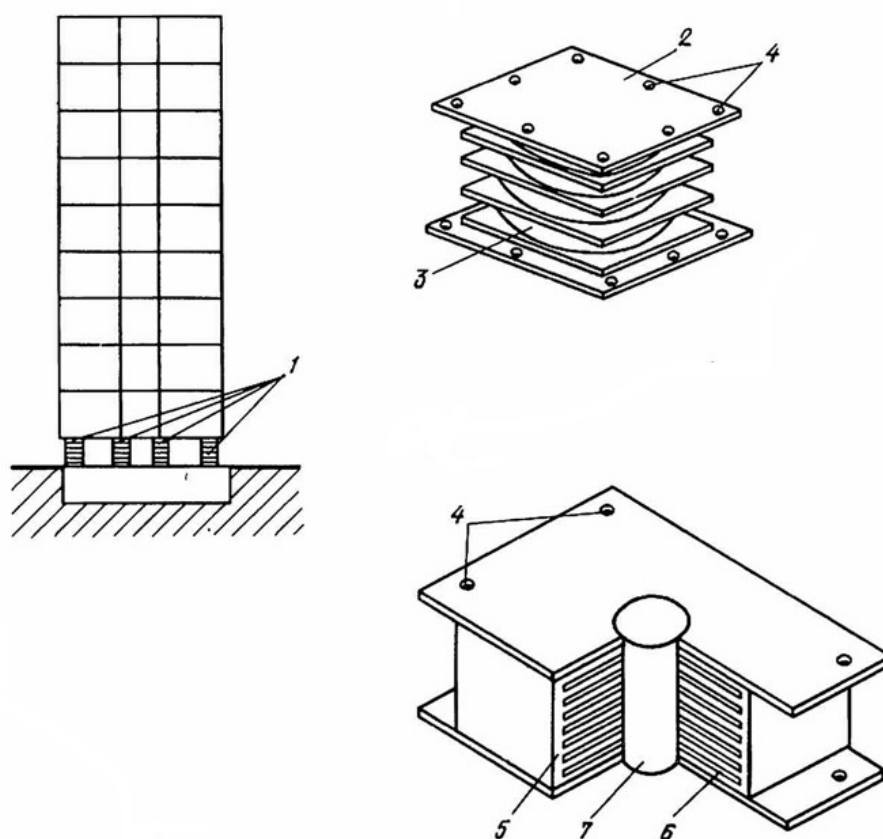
Сейсмоизоляция здания с помощью резинометаллических опор.
